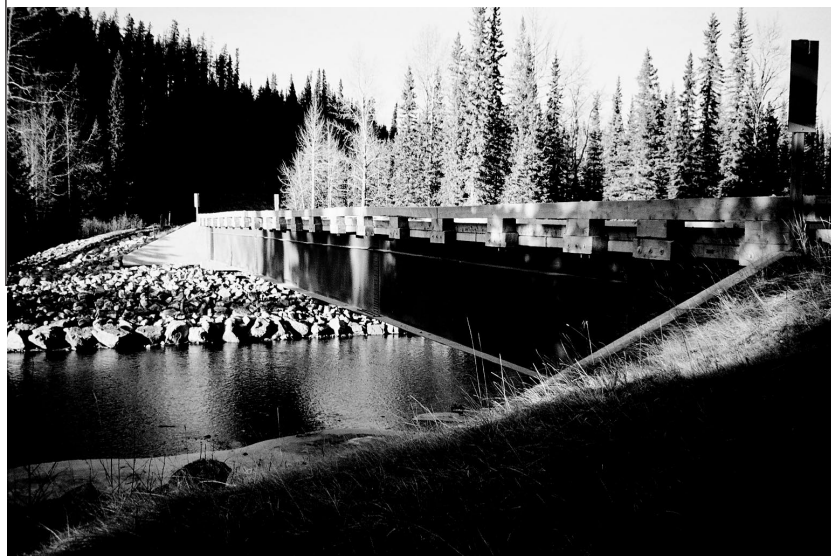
Pont sur la rivière Ram, RAF (5 novembre 2002)
